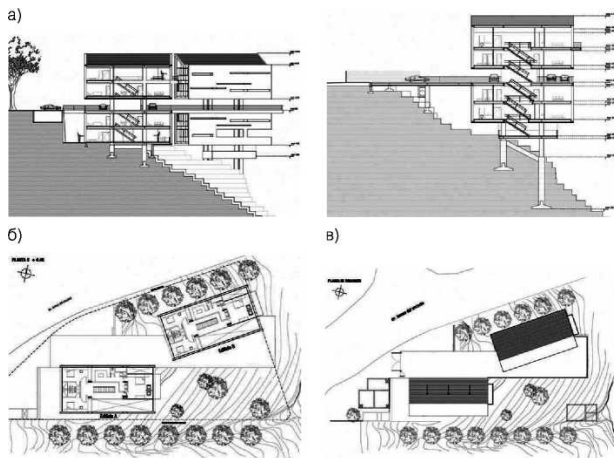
Терасовий будинок в Мехіко (Мексика): а) розріз 1 та розріз 2; б) план першого поверху; в) план покрівлі[3].
